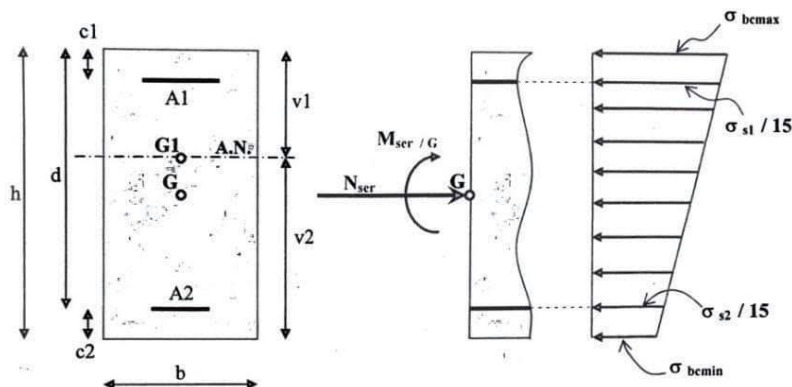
Coupe transversale d'une poutre sollicitée a LELS.
